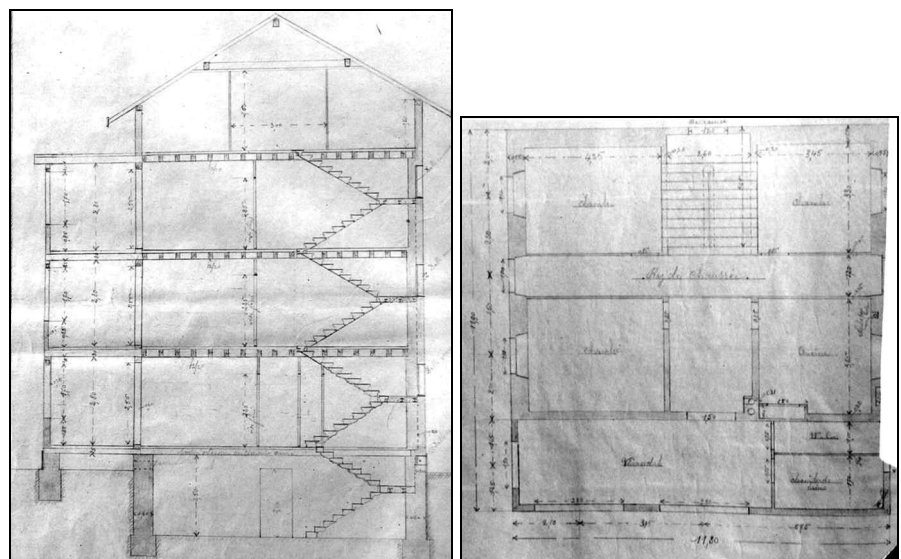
Coupe transversale et plan du rez-de-chaussée du bâtiment n°12
